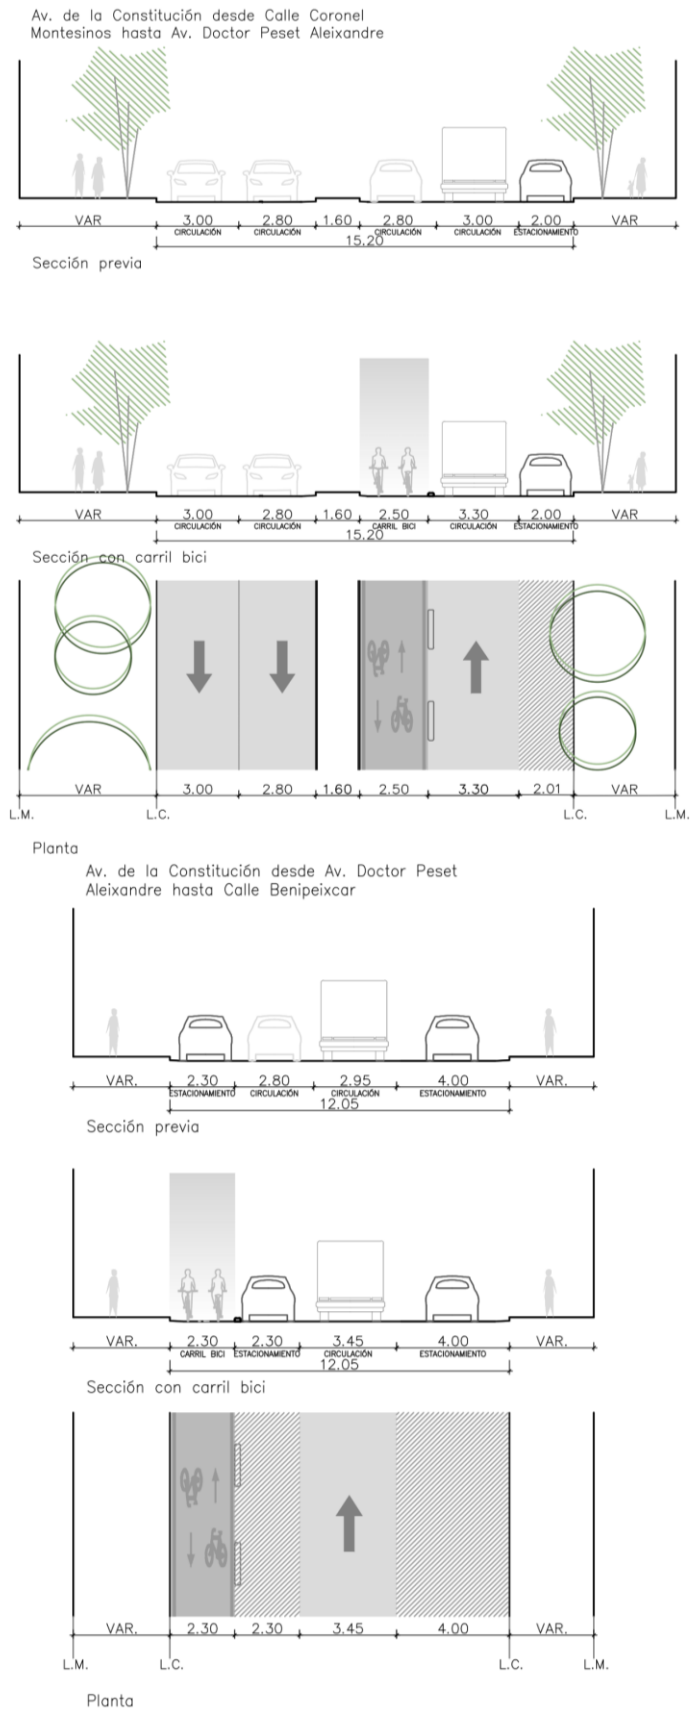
Av. de la Constitución - Sección previa y posterior a la implantación del carril bici
